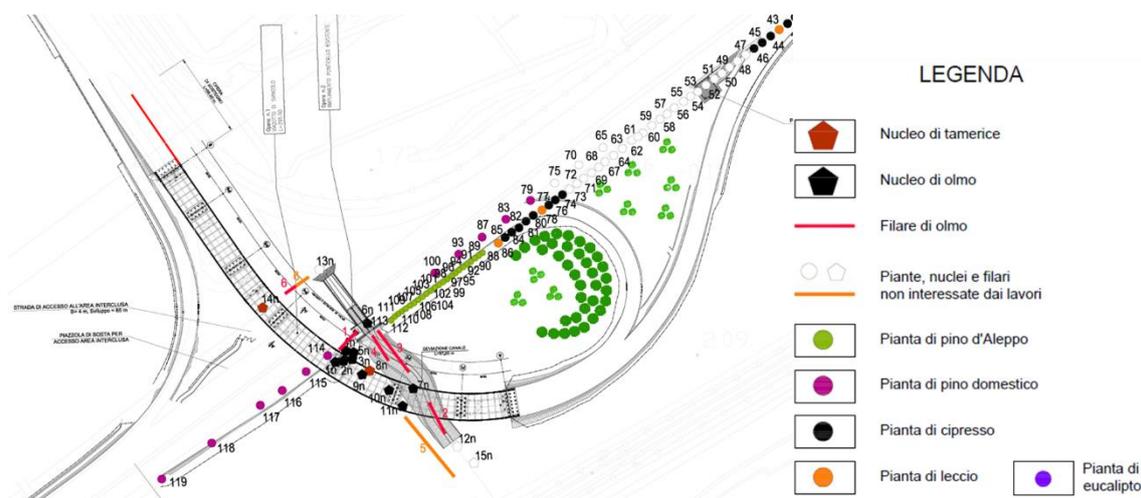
Censimento vegetazionale su planimetria di progetto
